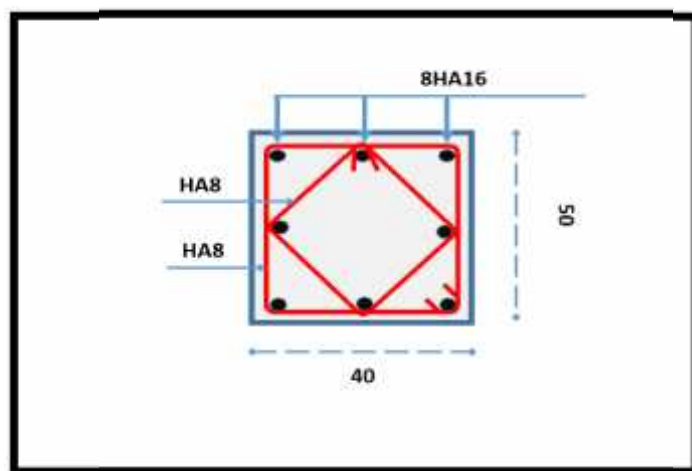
Schéma de ferrailage des Poteaux (50x40)
